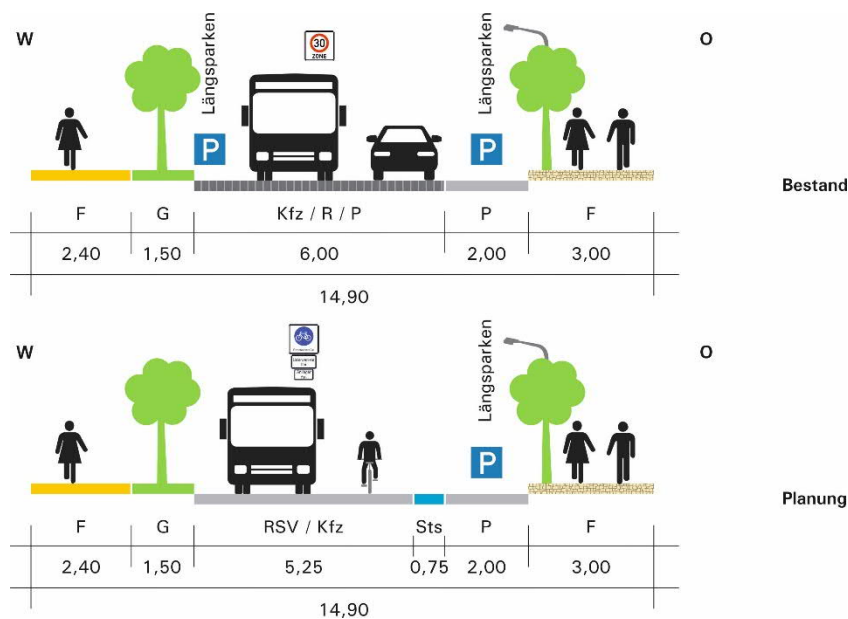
Querschnitt Abschnitt Ahrensburger Weg (A-08; Bestand und Planung)
